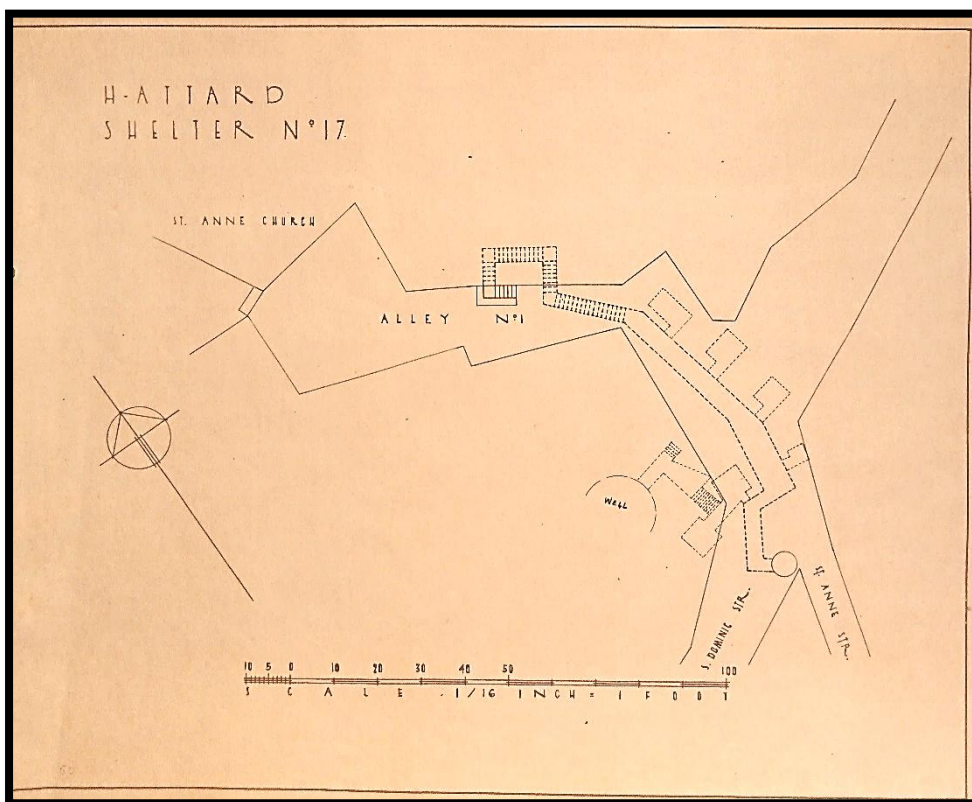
Planta do Abrigo nº17 "Alley nº1"
